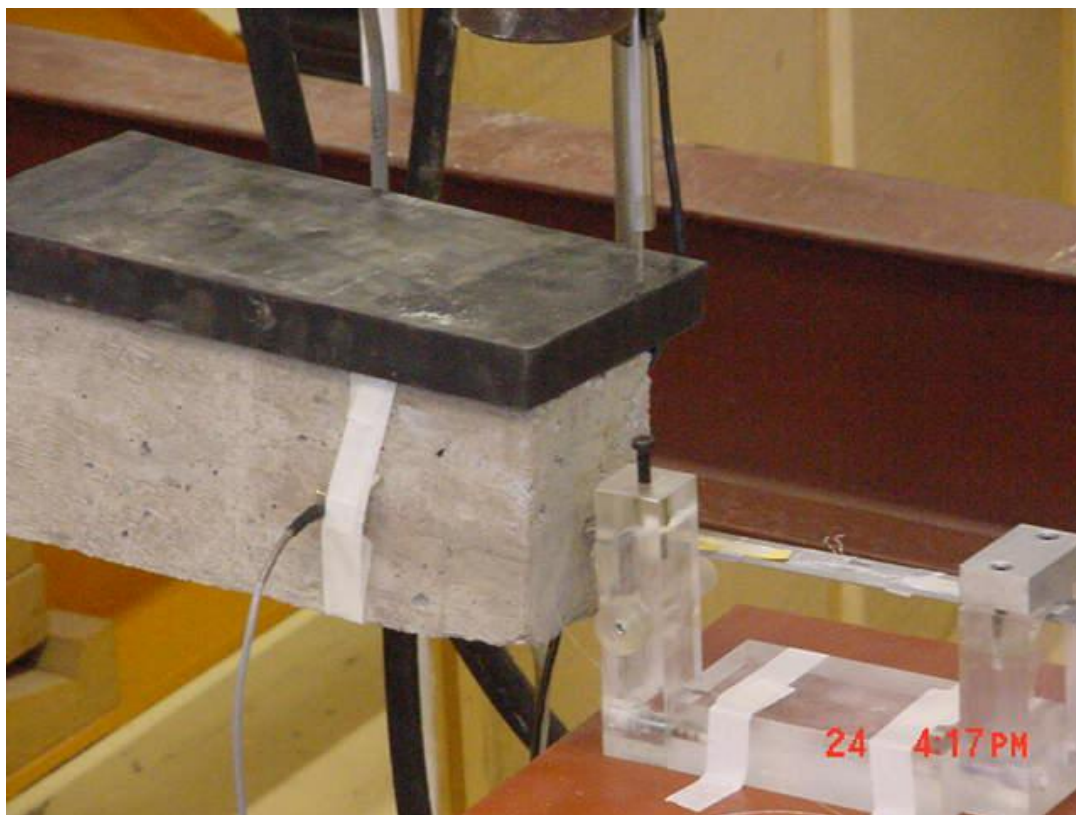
Arranjo de ensaio e instrumentação da viga de concreto
